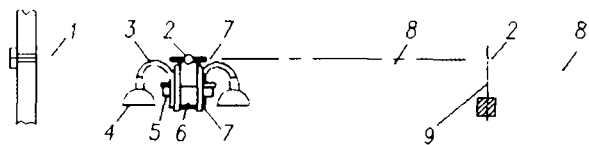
Прокладка тросовой проводки поперек ферм: 1 — концевое крепление троса; 2 — ответвительная коробка; 3 — кронштейн ОП; 4 — ОП; 5 — ПРА; 6 — нижний пояс фермы; 7 — провод в изоляционной трубке; 8 — кабель, проложенный по тросу; 9 — ОП (условно не показан)
